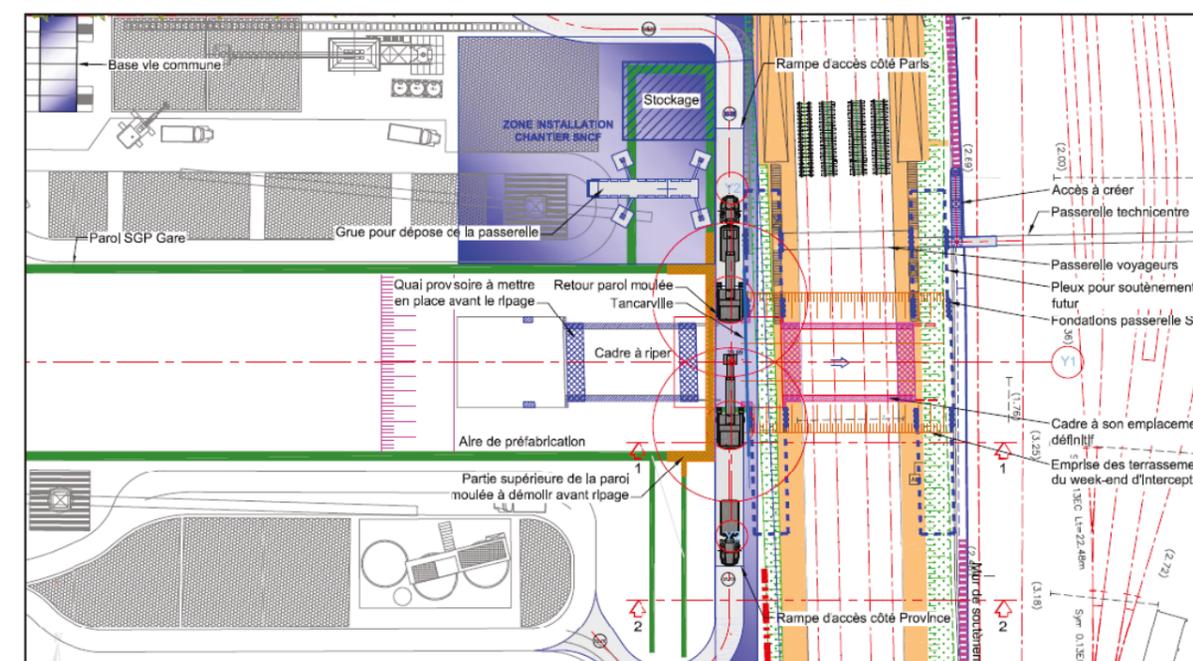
Ardoines - Plans limite des ERP - Plans AVP DDGT
